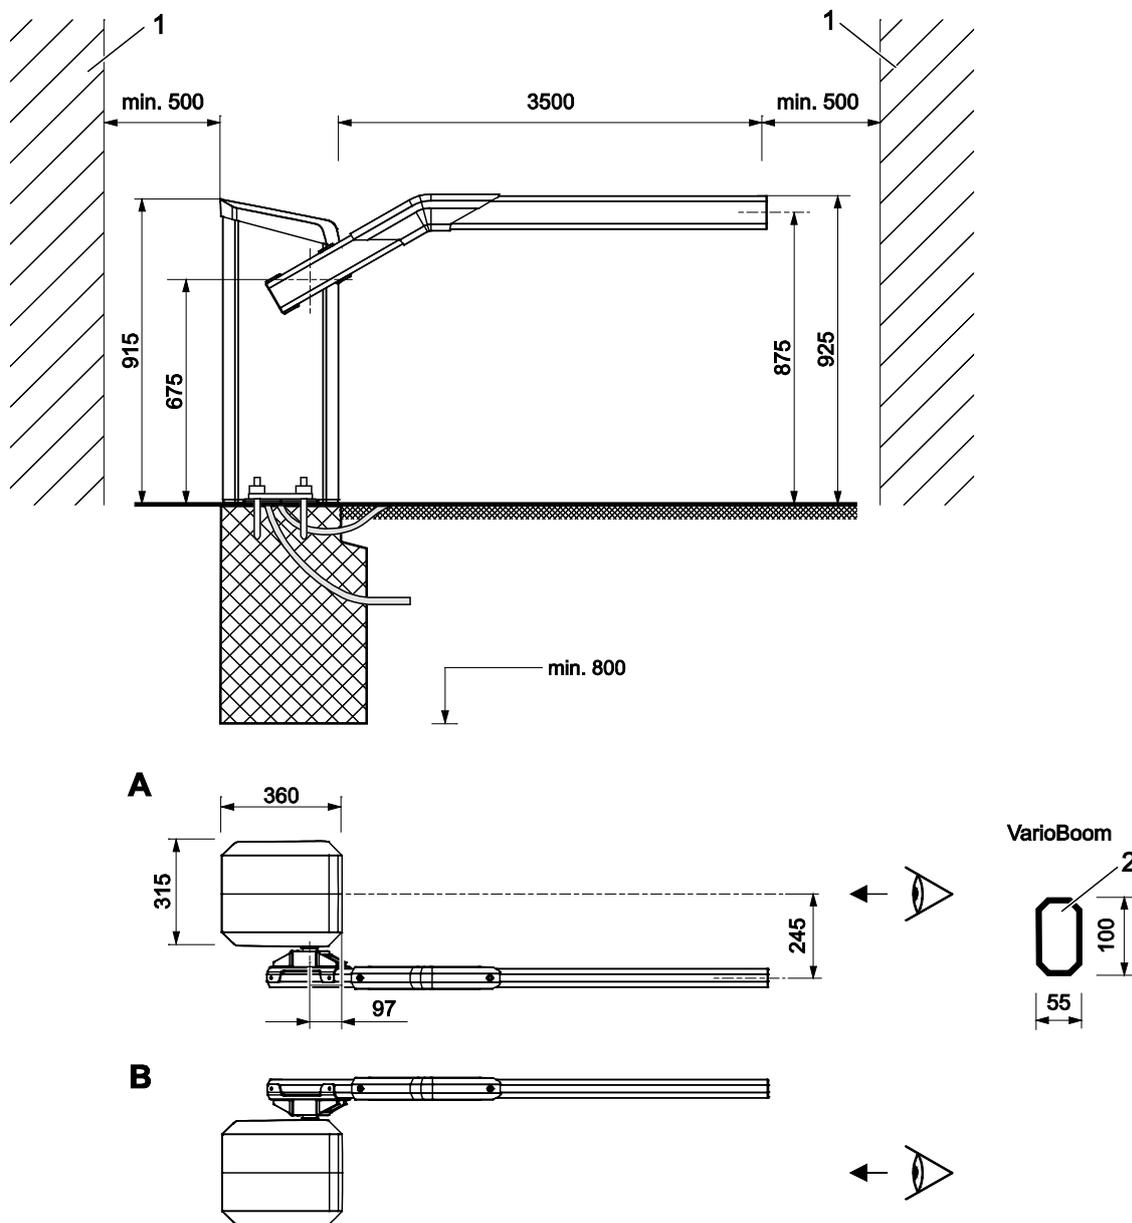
Abmessungen Schrankenanlage und Schrankenbaumprofil – Serie "Parking" (Maße in mm)
